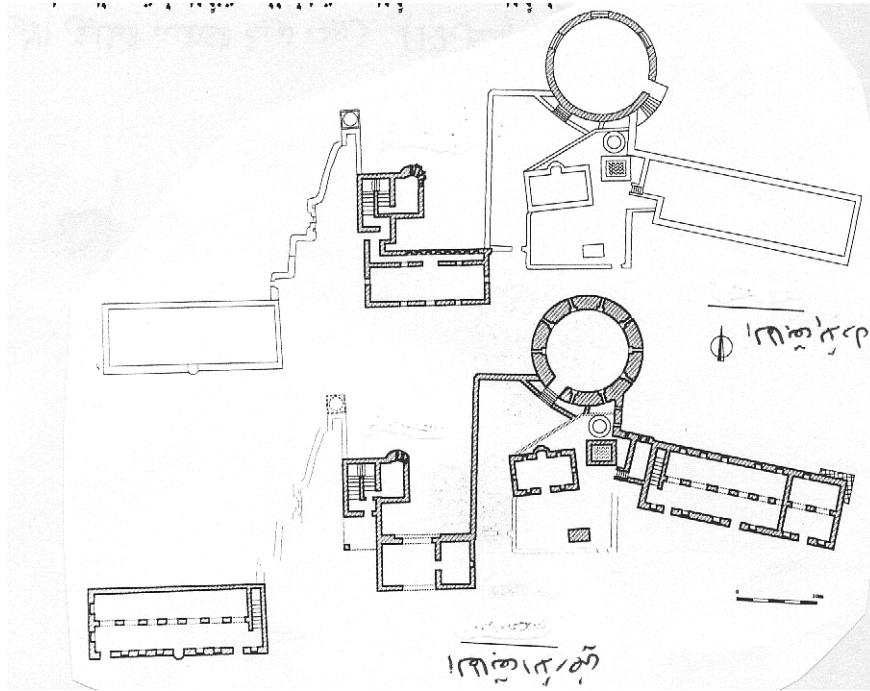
ب) زبيد، المسقط الأفقي لباب الشبارق
